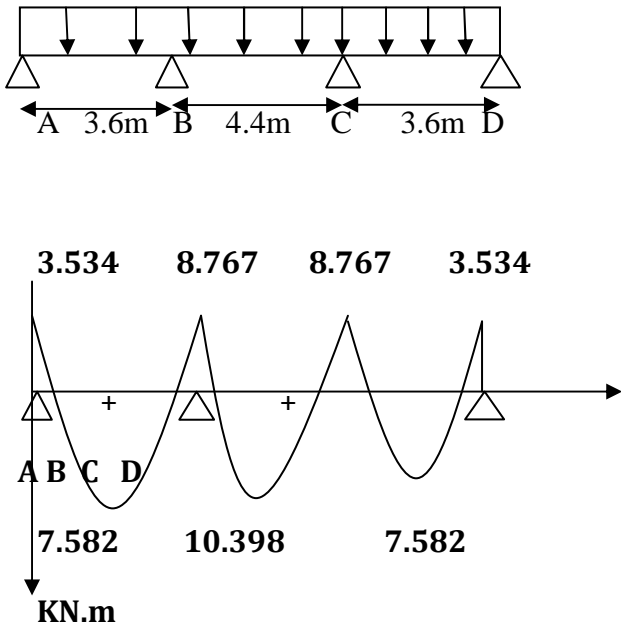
diagramme du moment fléchissant poutre continue N°2 à l'ELU
